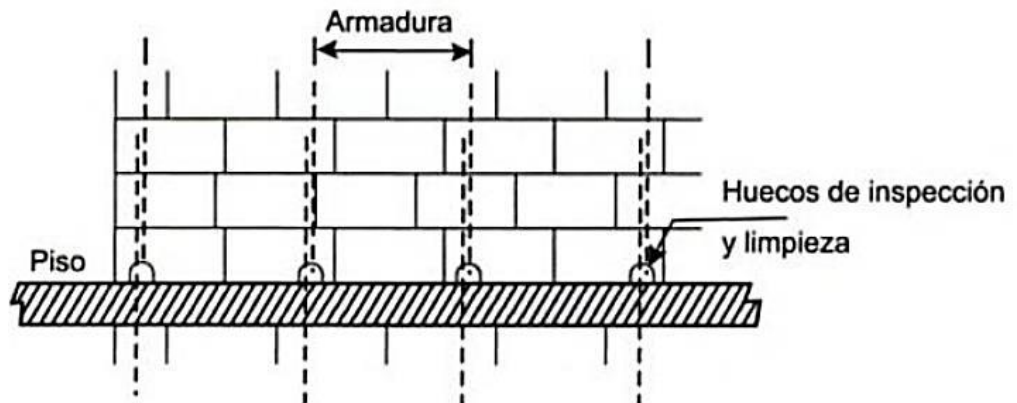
Detalle de muros de albañilería armada (Gallegos & Casabonne, 2005)
